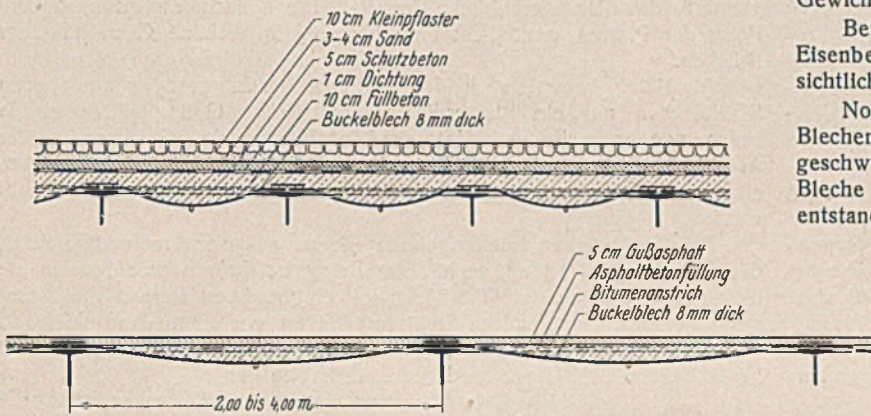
Schwere und leichte Fahrbahntafel mit Buckelblechen.
